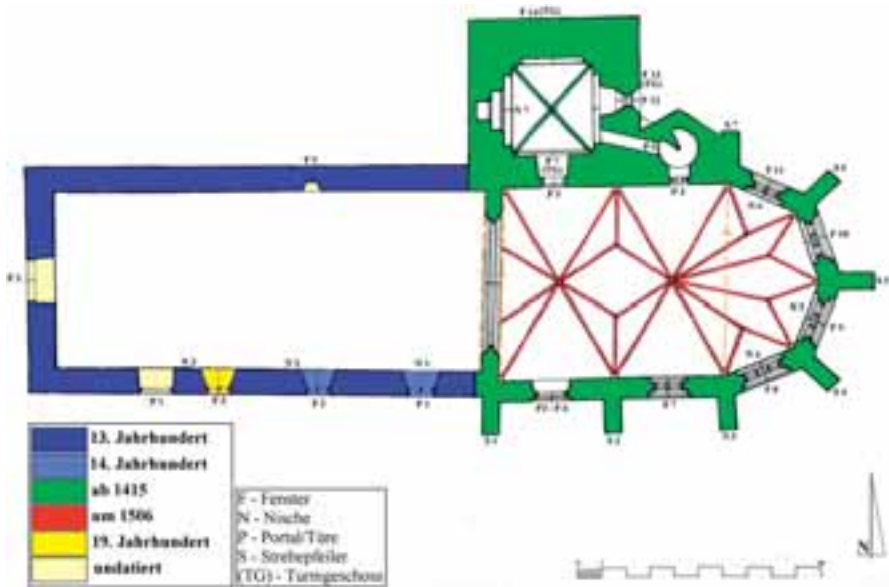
Marienkirche Bronnweiler, Bauphasenplan mit Nummerierung und Baufluchten (J. Widmaier nach H. Baum 1963).
